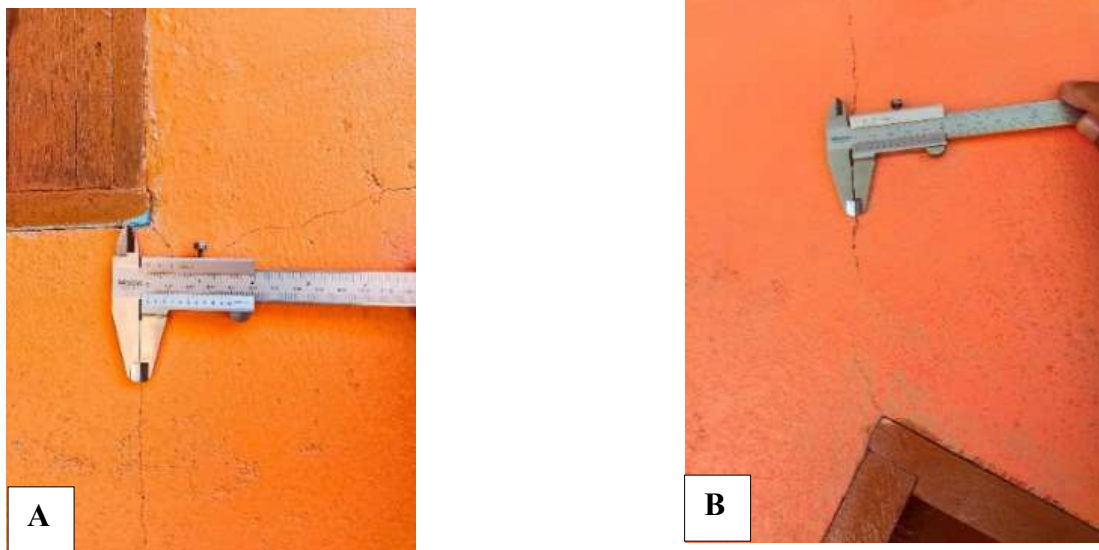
Presença de patologia: (A) fissuras verticais e horizontais na parte inferior janela. (B) trincas inclinadas na porta.
